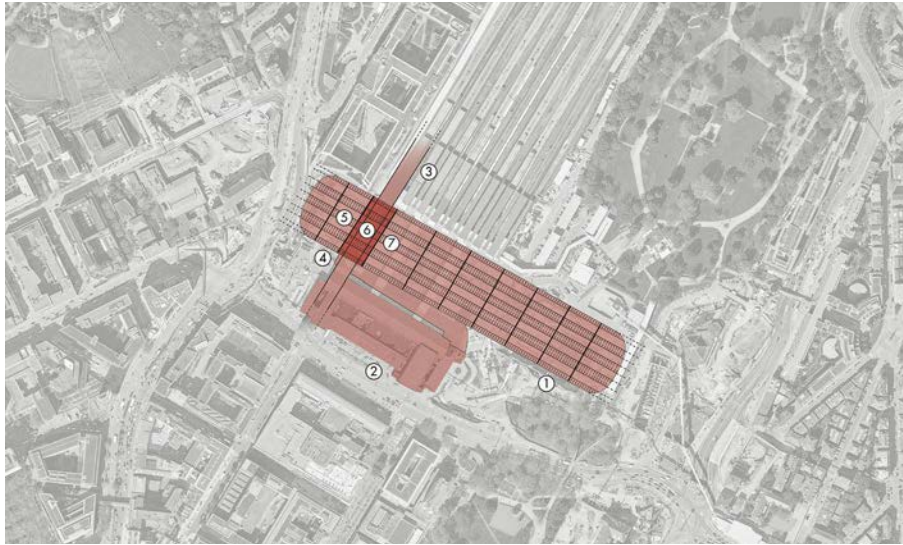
Grundriss des neuen Stuttgarter Bahnhofs: 1 der neue Tiefbahnhof, 2 bestehendes Bahnhofsgebäude, 3 S-Bahn-Strecke im Tunnel unter dem neuen Tiefbahnhof, 4 S-Bahn-Querung des neuen Tiefbahnhofs, 5 Bauabschnitt 10, 6 Bauabschnitt 11 (S-Bahn-Querung), 7 Bauabschnitt 12
